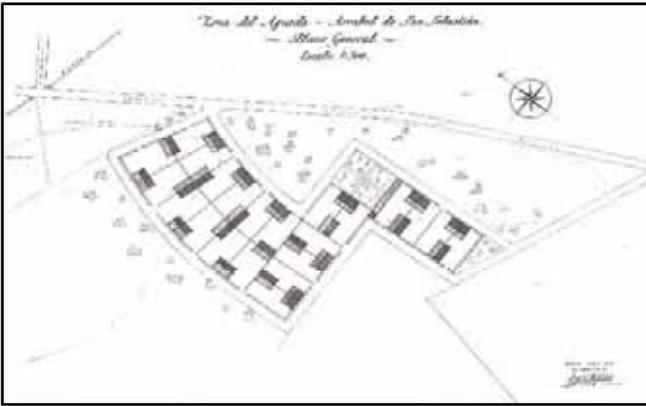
Arrabal de San Sebastian. Planimetria generale –
